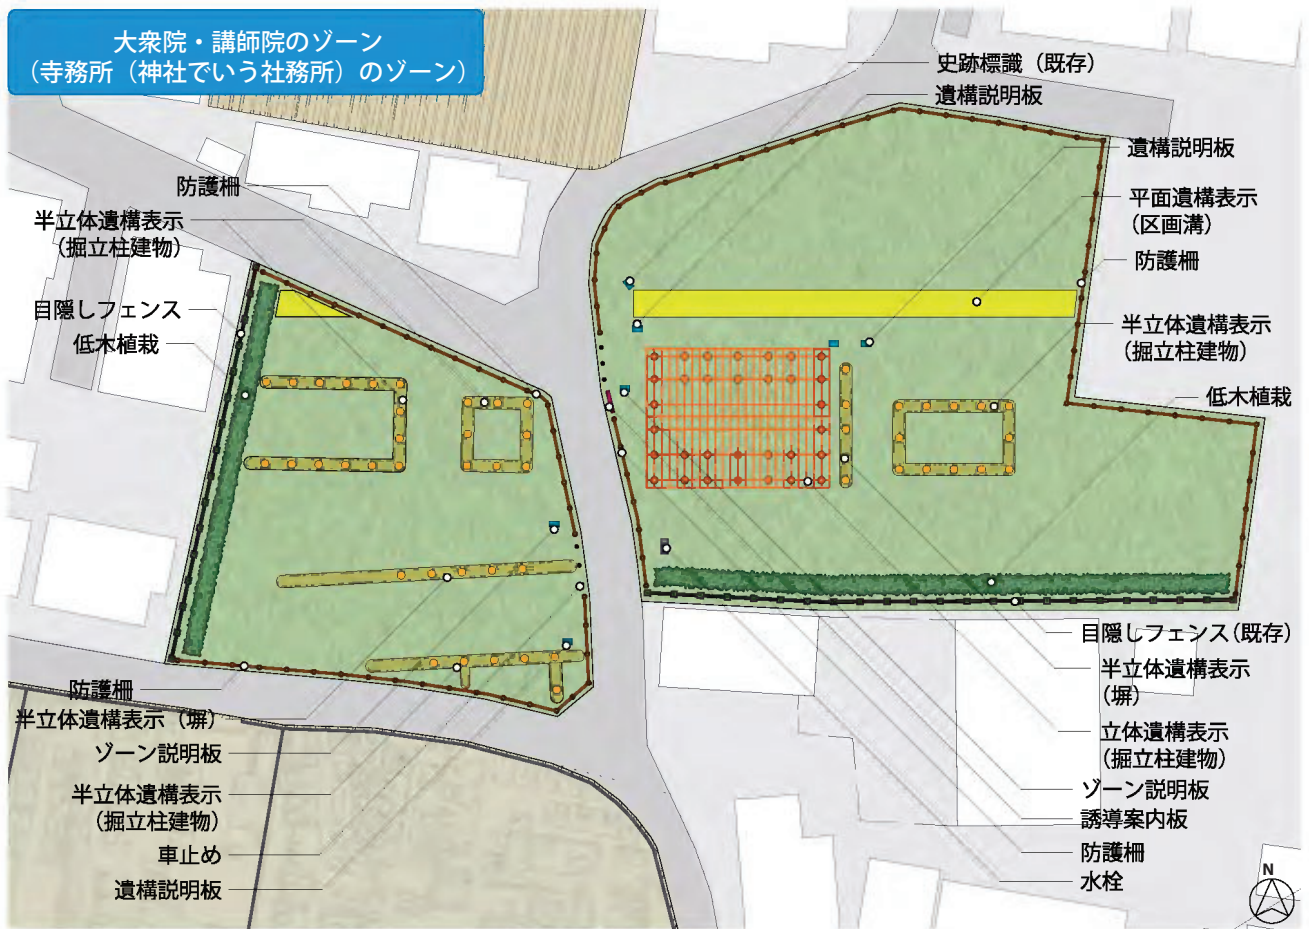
整備基本計画図 大衆院・講師院のゾーン平面図 (縮尺: 1/600)
